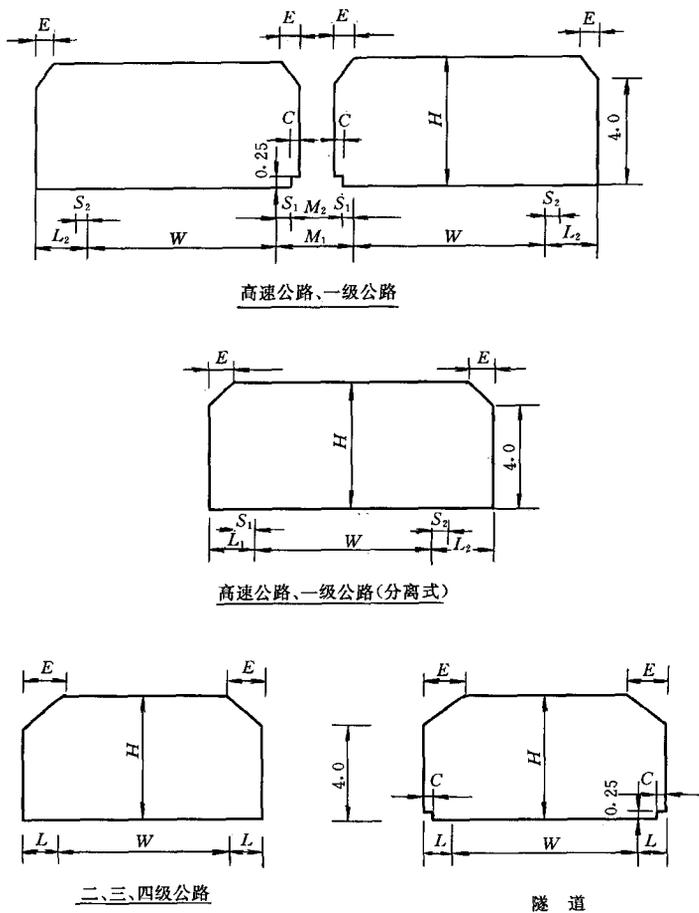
高速公路的建筑限界 (尺寸单位: mm)
